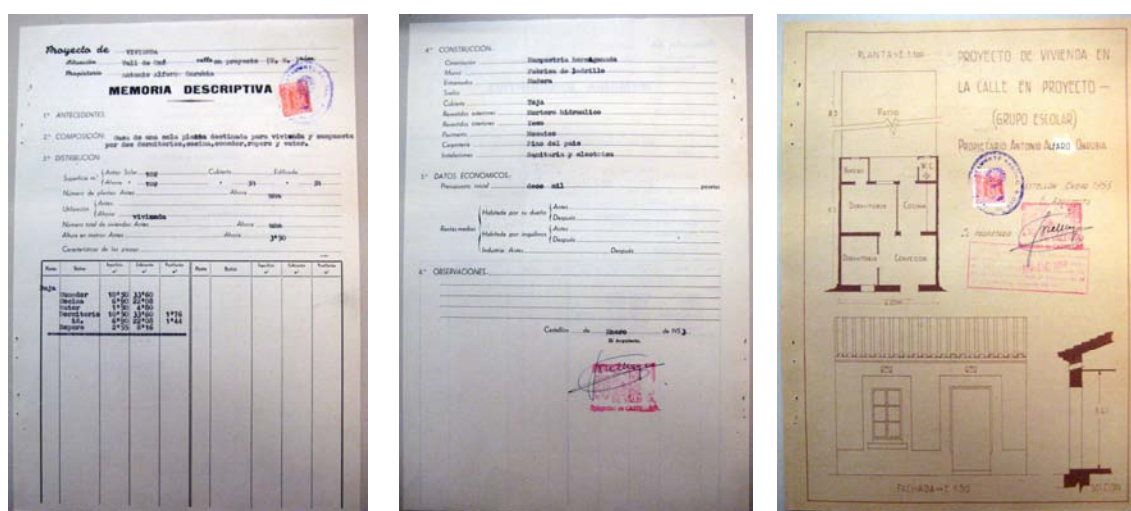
5. LA VALL D'UIXÓ: Expediente de licencia de obra mayor: proyecto suscrito por arquitecto y visado por el Colegio de Arquitectos de Castellón. (Fuente: Archivo Municipal de La Vall d'Uixó, caja 1 signatura 1/33/1953)
